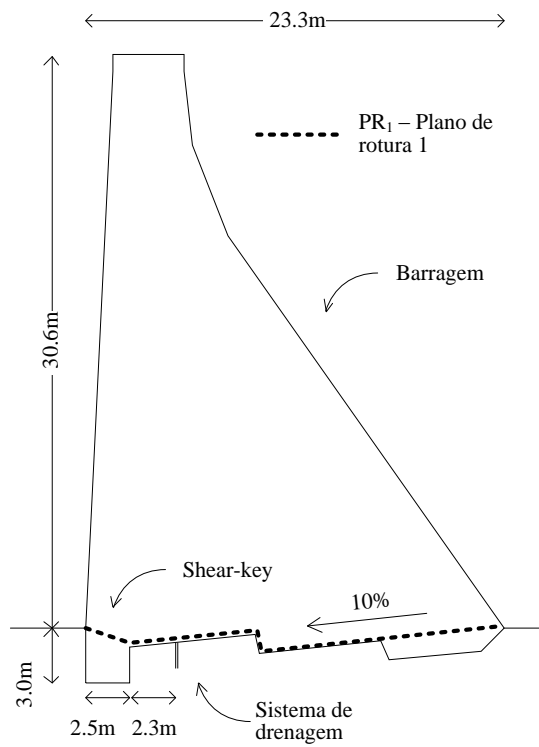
Pormenor do plano de inserção e do plano de rotura 1 (PR₁)
